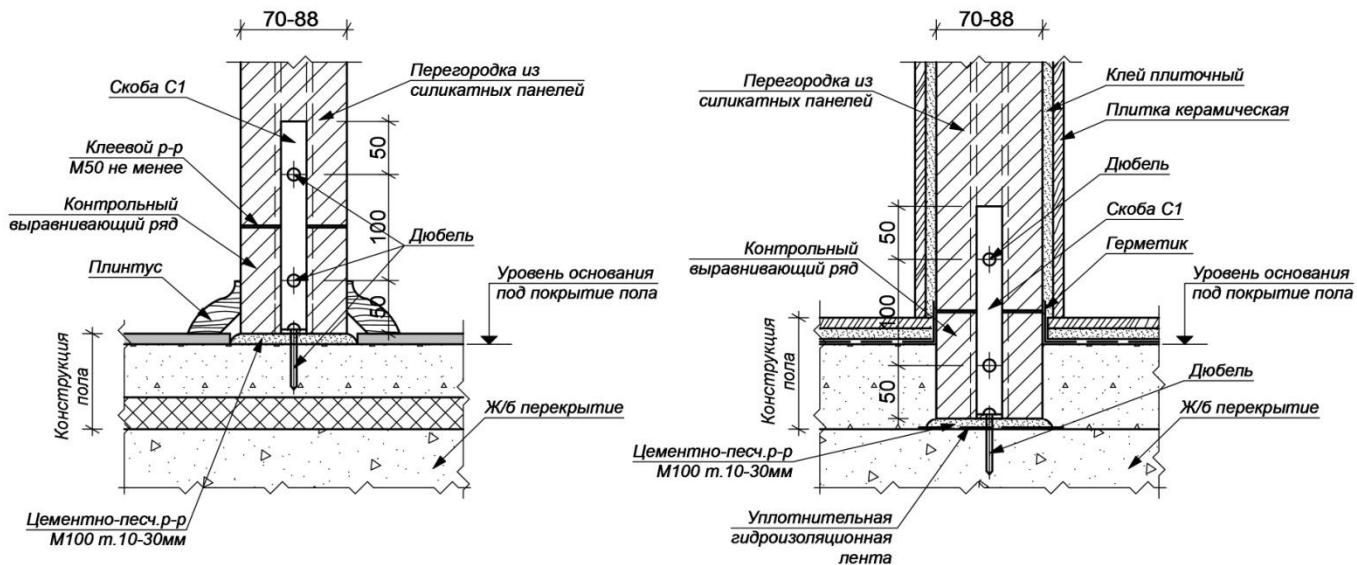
Узлы примыкания межкомнатных перегородок к перекрытию
